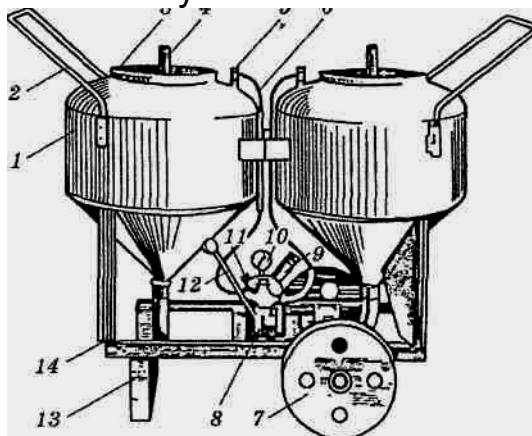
Схема шпаклювального агрегату з установкою СО-21А:
